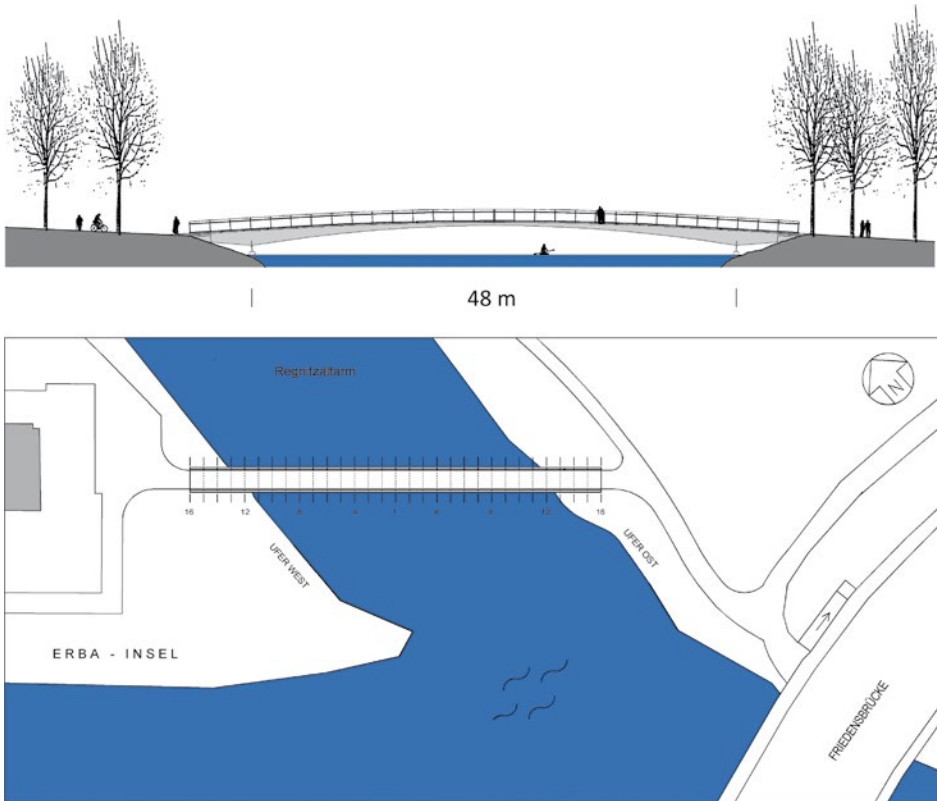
Ansicht und Lageplan Erbasteg
